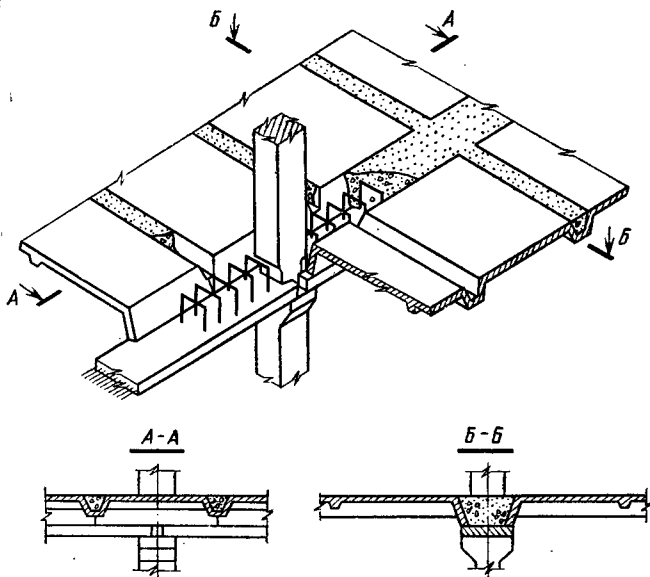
Ребристые сборно-монолитные перекрытия с остовом из железобетонных панелей
